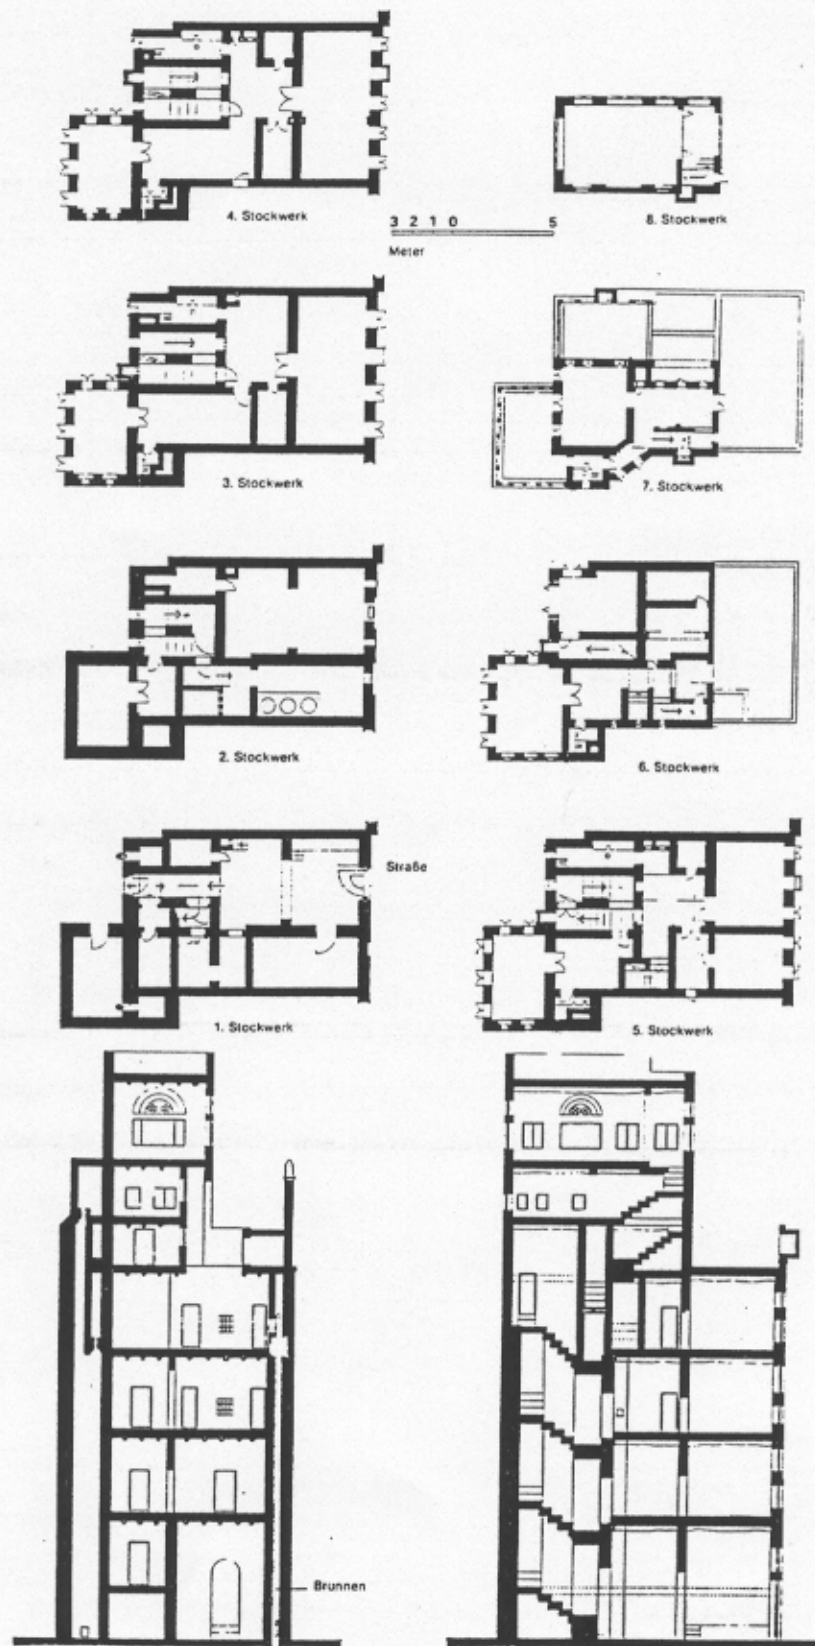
Grundrisse, Quer- und Längsschnitte durch ein typisches Turmhaus von Sana'a
